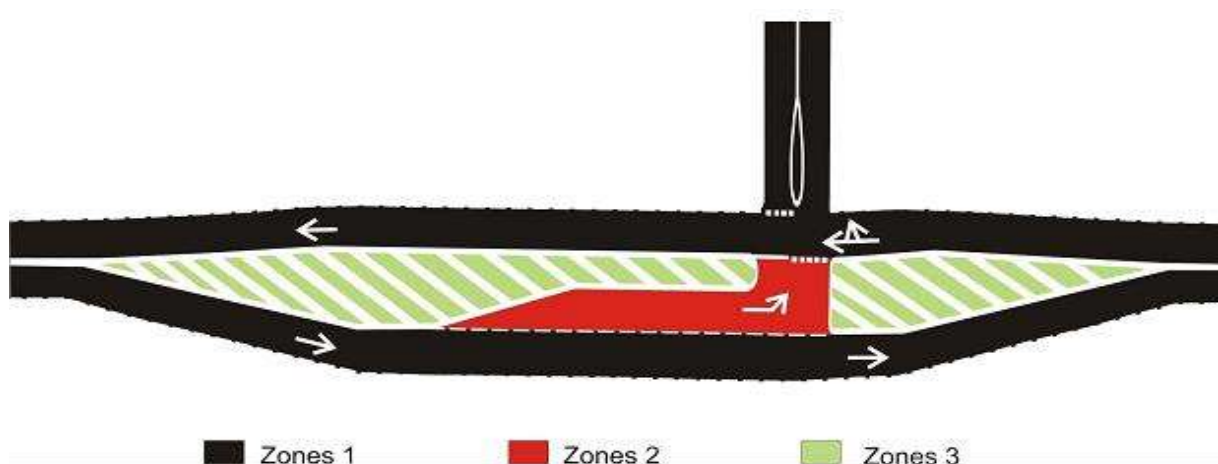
Répartition des zones de chaussées sur route bidirectionnelle avec carrefour plan élaboré
